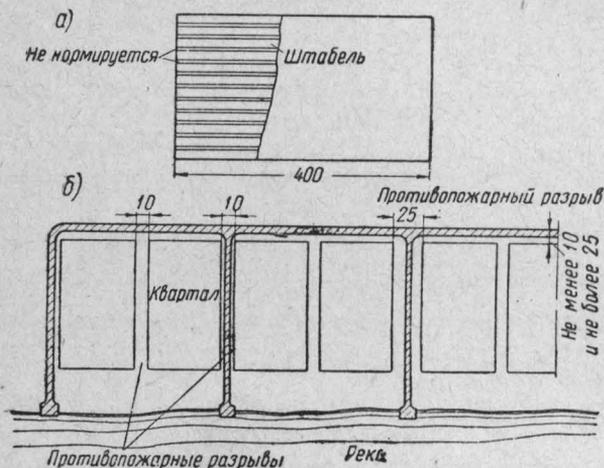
Склады круглого леса при хранении бревен в осенне-зимний период года:
